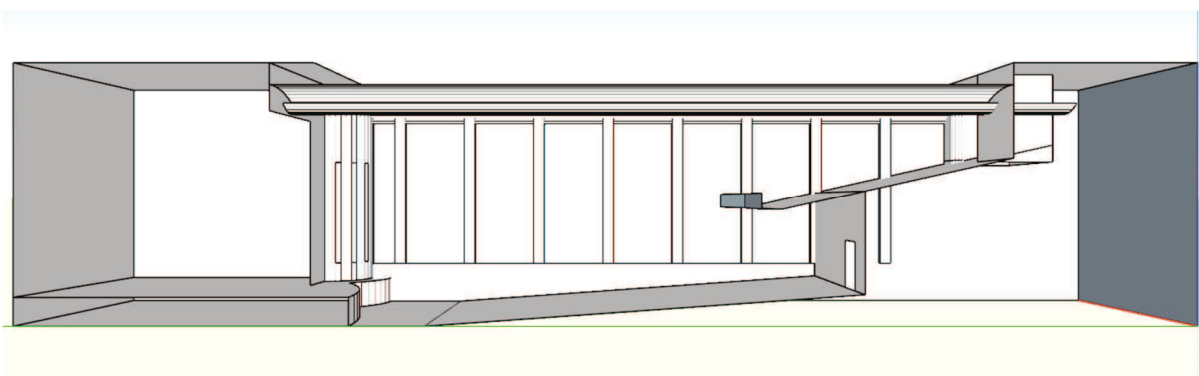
Cine Teatro Luz - Corte longitudinal esquemático da geometria tridimensional completa.
